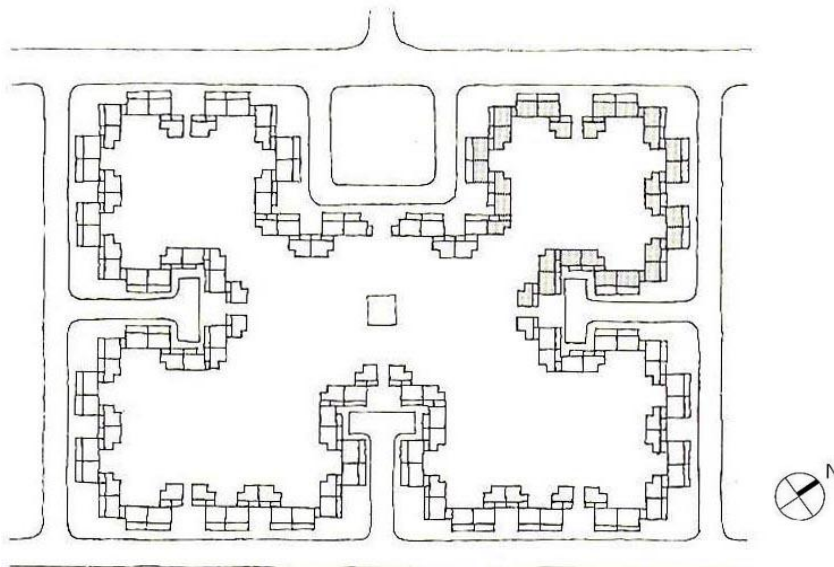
Plano de situación, tipología J. Disposición unidades tipo
